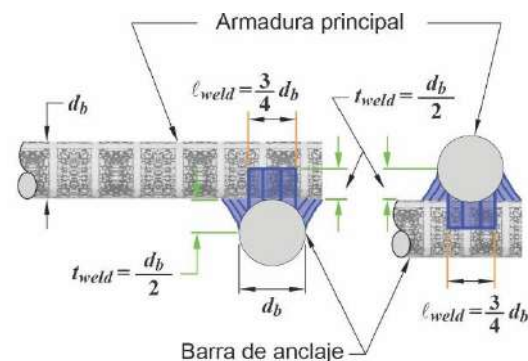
Detalles de la soldadura usada en los ensayos de Mattock et al. (1976a)
